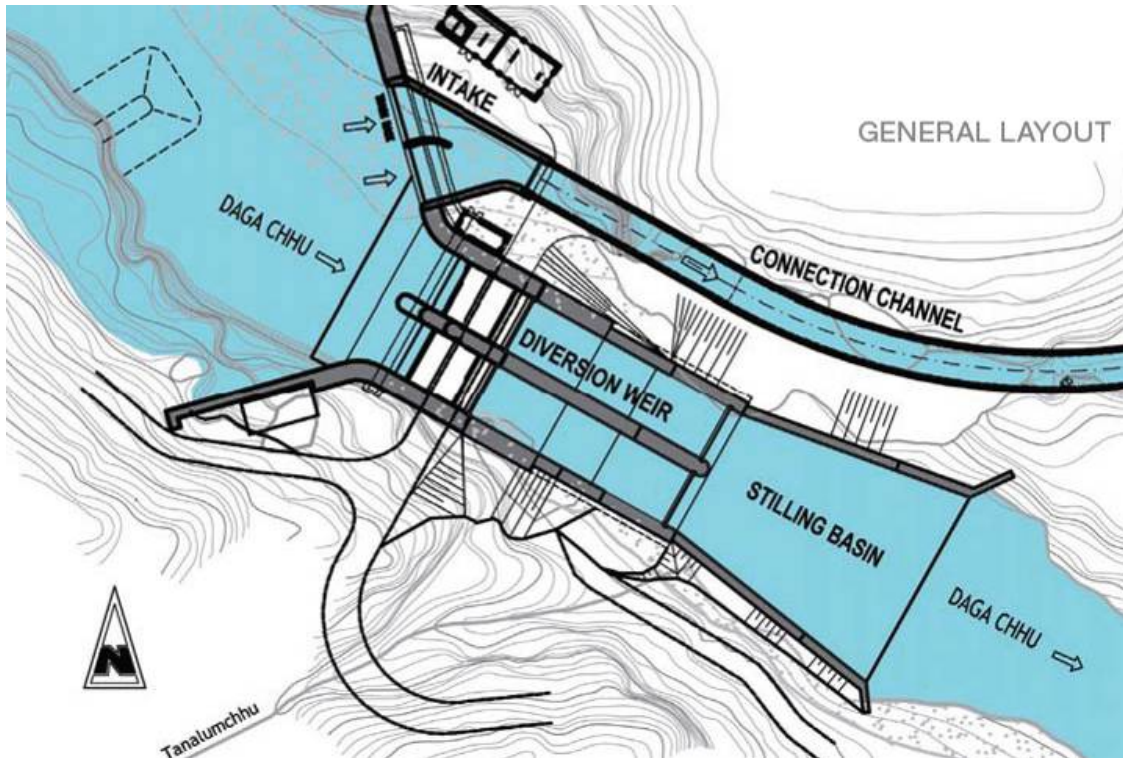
Grundriss Wehr Dagachhu (Machbarkeitsstudie)
